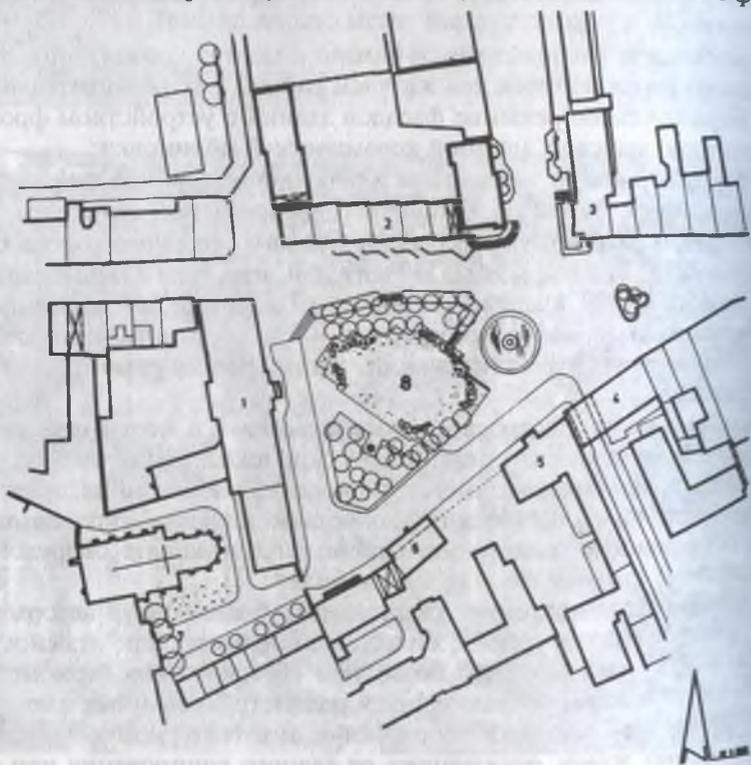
Ситуационный план Университетской площади в г. Ростоке (Германия): 1 — главное здание университета; 2 — пятифронтный дом; 3 — угловое реконструированное здание; 4 — зал; 5 — дворец; 6 — караульная; 7 — монастырь Св. креста; 8 — Университетская площадь
